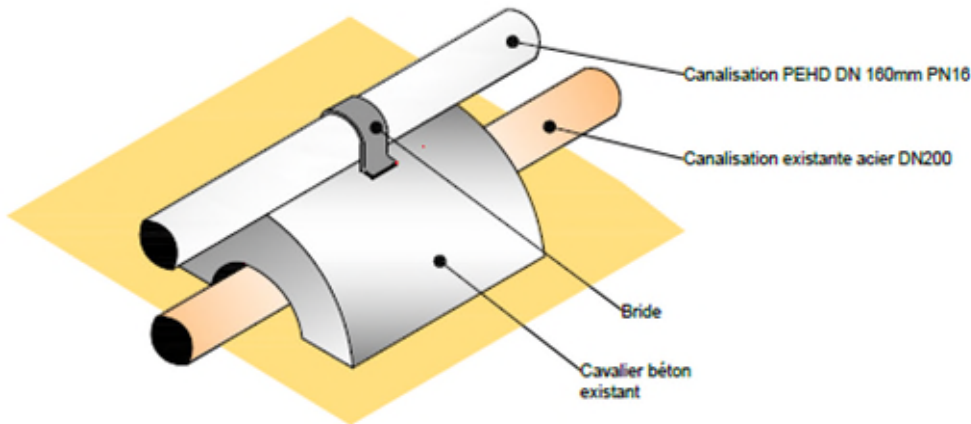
Schéma du principe de pose et fixation conduite PEHD 160 sur cavalier béton existant
